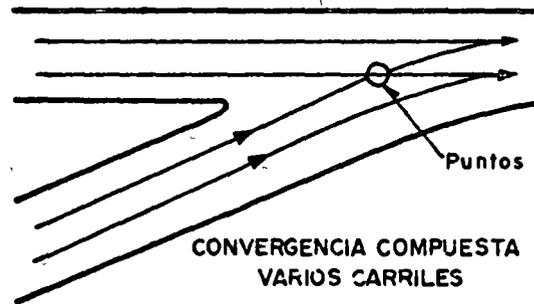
TIPOS DE ZONAS DE ENTRECruzamiento
